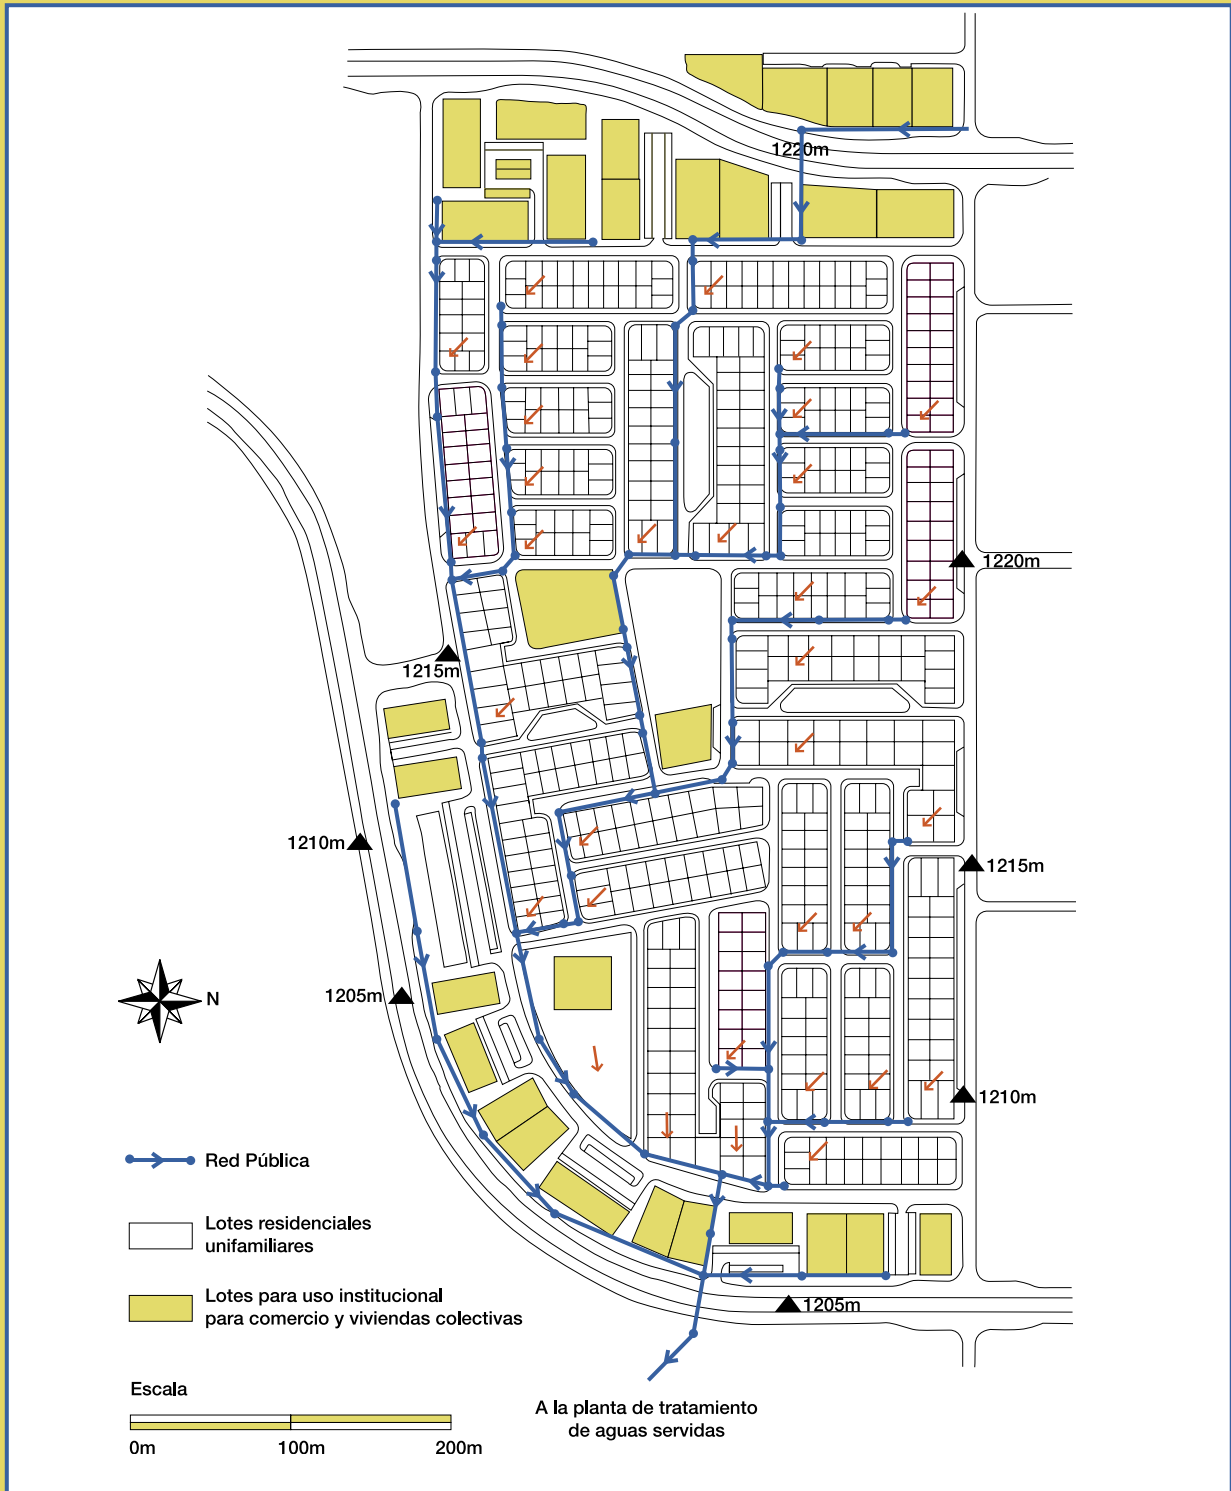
Concepto de diseño total del sistema de alcantarillado condominial en Santa María
